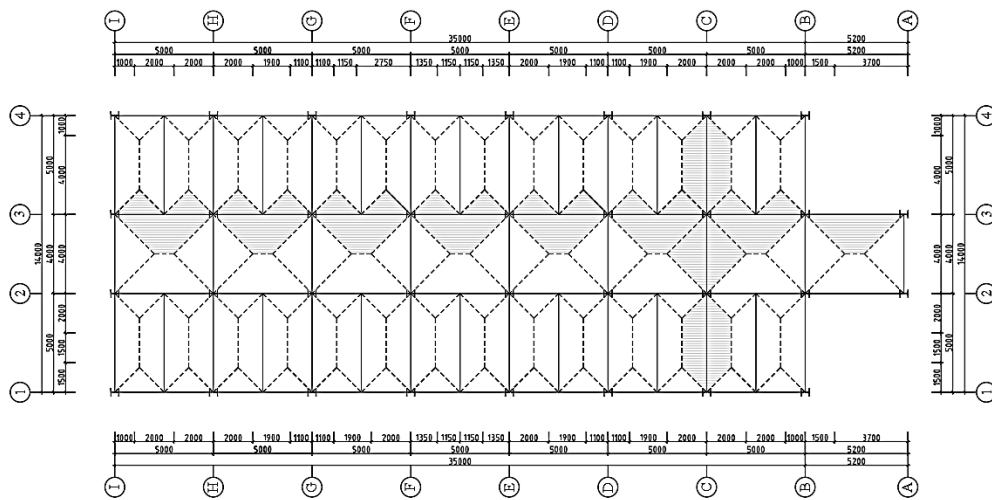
Denah Potongan Portal As C dan Portal As 3 Lantai 1
